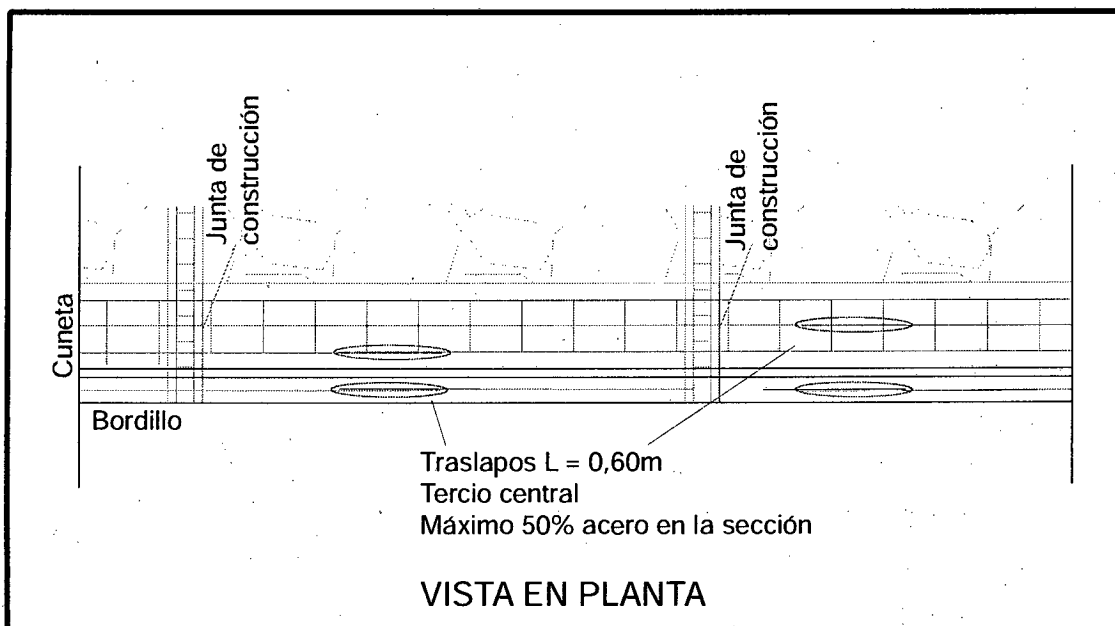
Junta Transversal de Construcción en la Berma-cuneta
